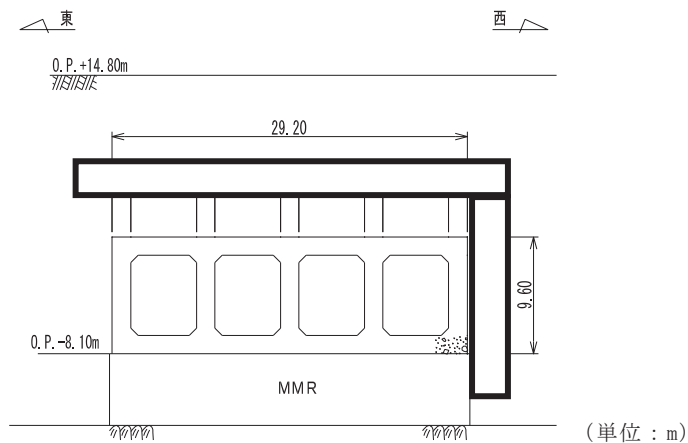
取水路 (漸拡部) の断面図 (A-A 断面)
